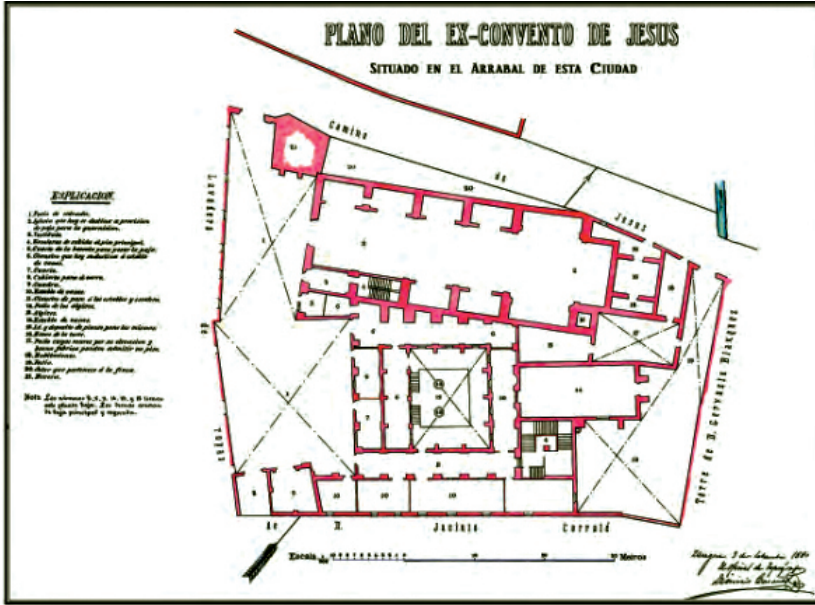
Plano del Monasterio de Santa María de Jesús. Fuente: Archivo General Militar de Segovia [AGMS], Sección 3º, División 3º, legajo 789, f. 1 r-2v.¹⁶
